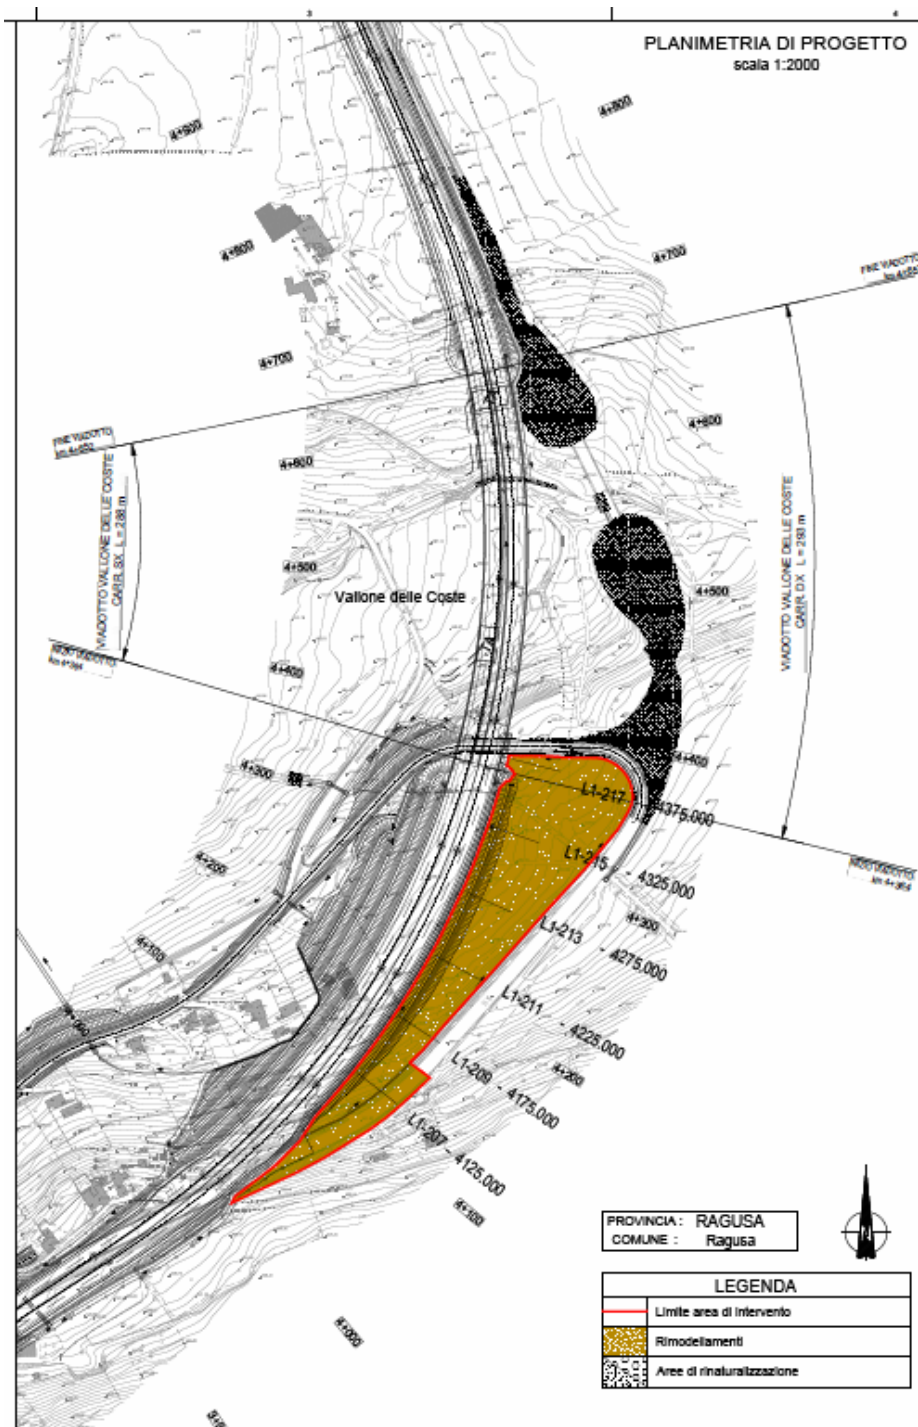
stralcio planimetrico dell'intervento di rimodellamento e rinaturalizzazione
